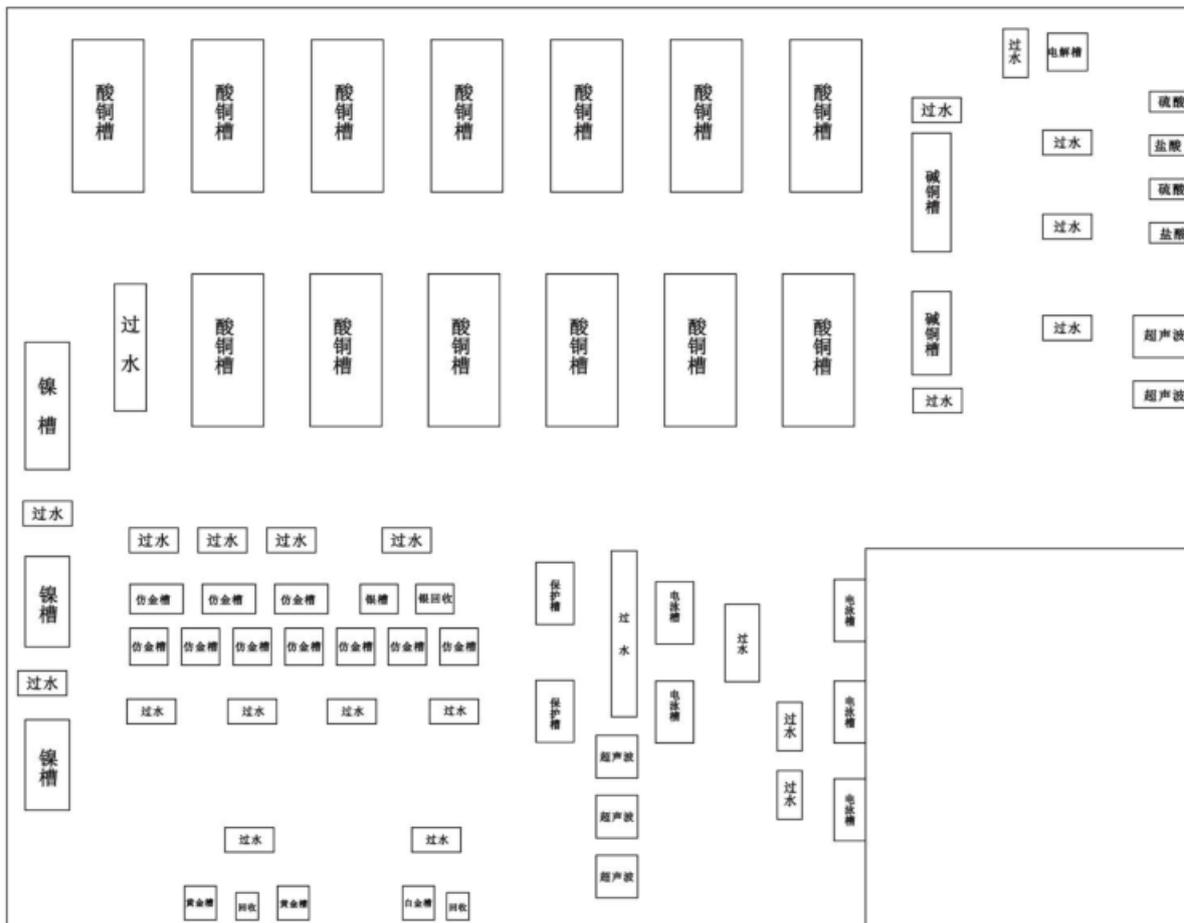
A 栋生产厂房 1 楼 4 车间平面布置图
